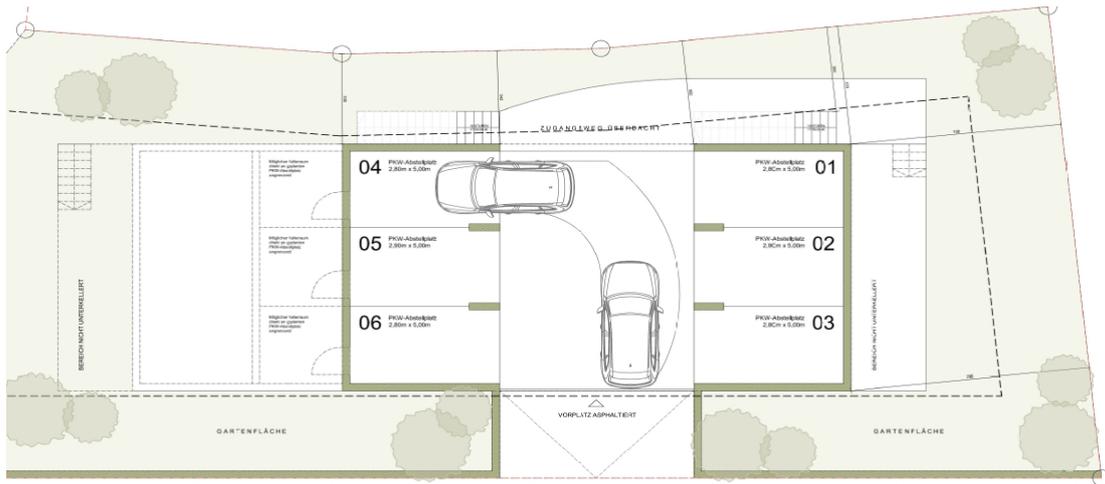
Grundriss UG, COMMOD HOUSE vom 13.08.2021
